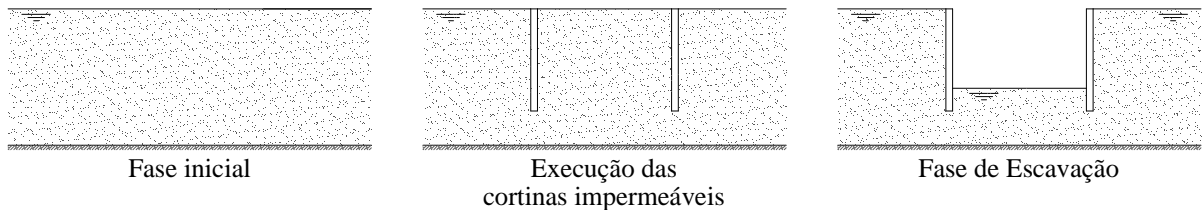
Faseamento construtivo simplificado de uma cortina impermeável
